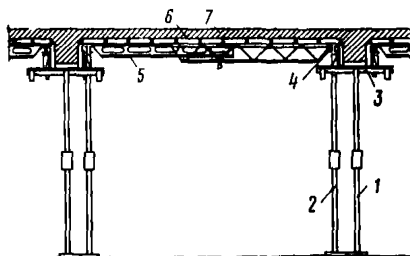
Схема опалубки перекрытия, опирающегося на железобетонные монолитные балки
